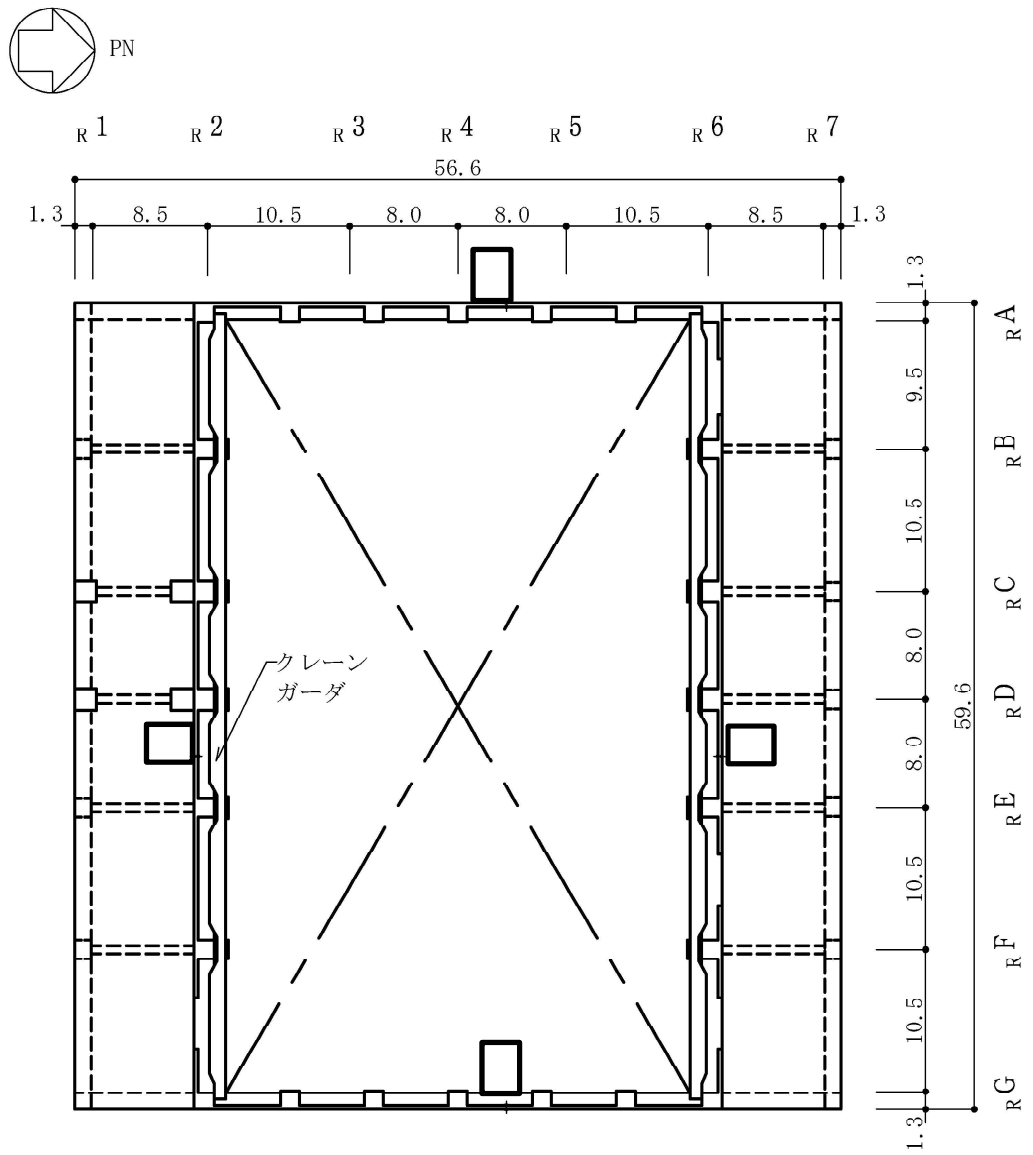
原子炉建屋の概略平面図 (CRF, T. M. S. L. 38.2m) (8/9) (単位 : m)
